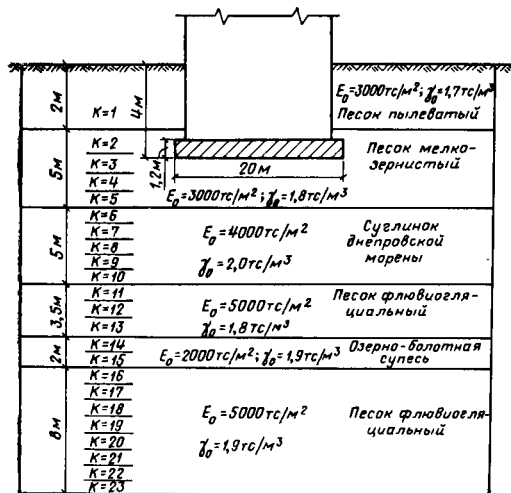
Геологический разрез основания фундаментной плиты (масштаб условный)
